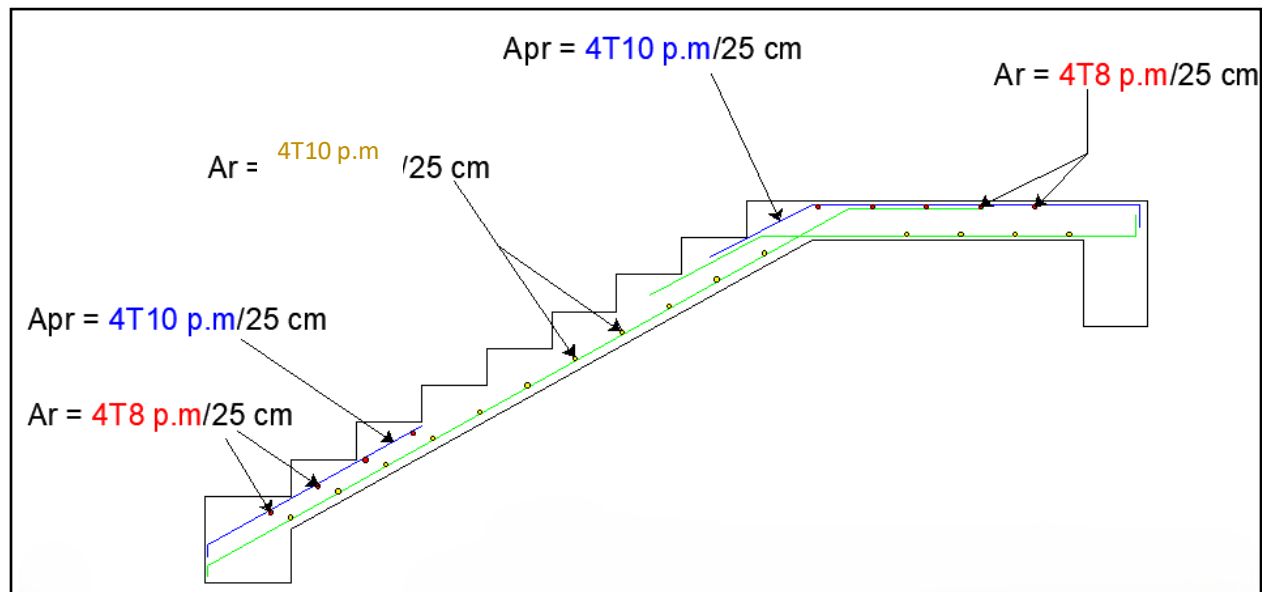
Schéma de ferrailage de l'escalier (par autocad)
